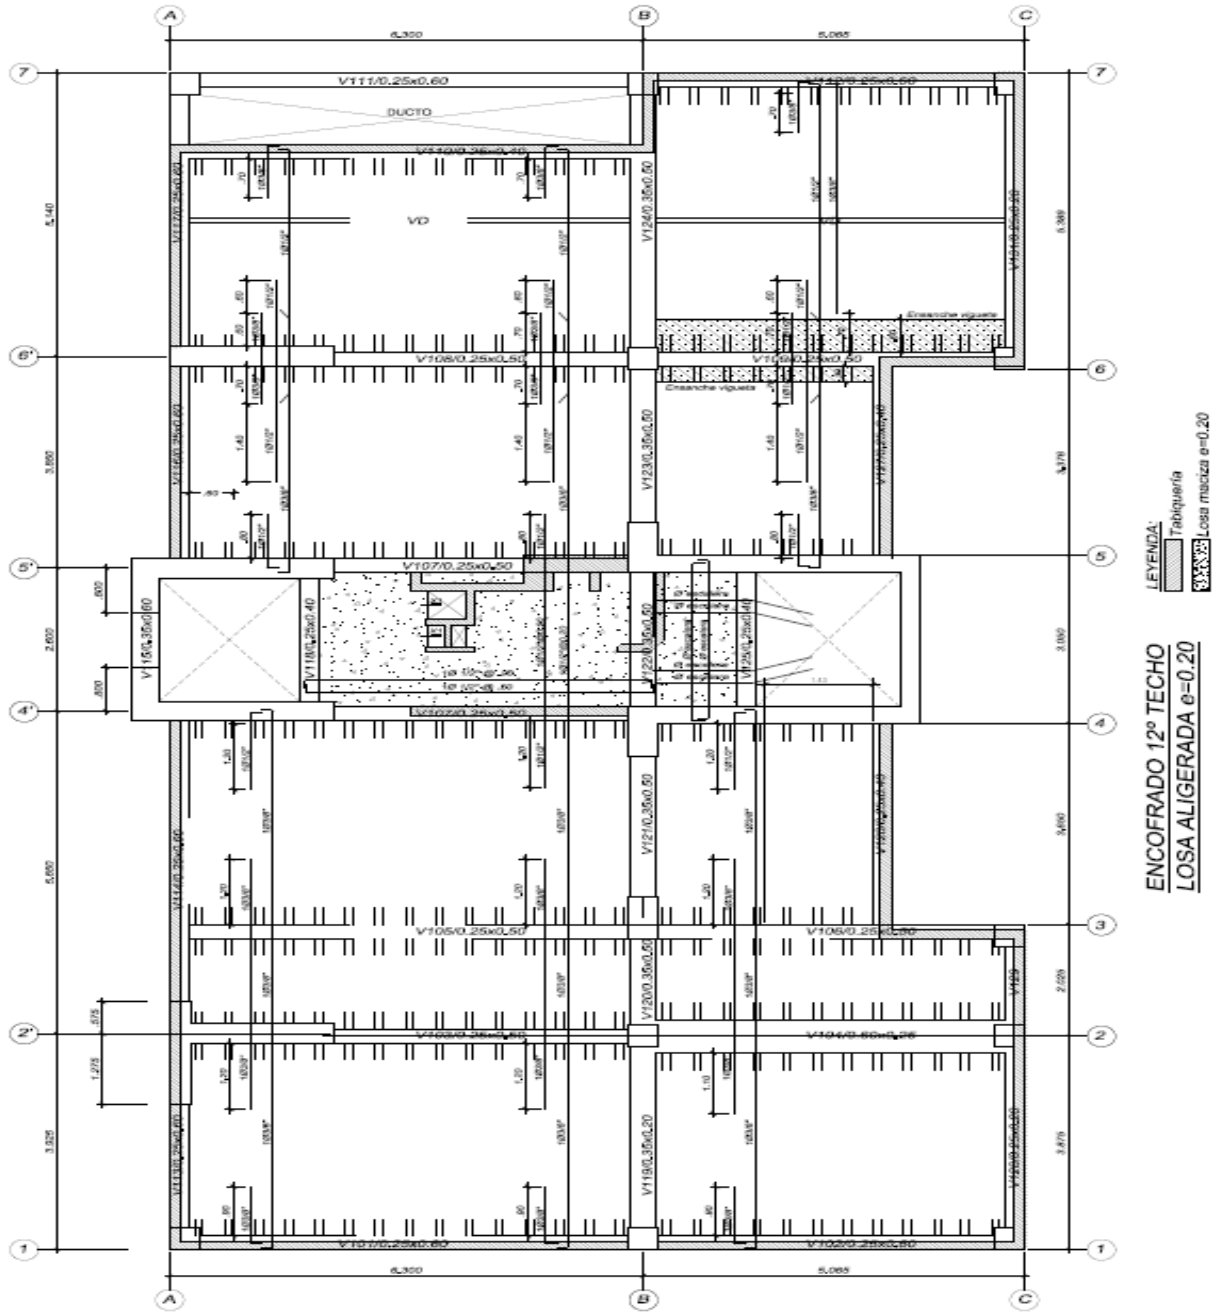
Detalle del refuerzo dispuesto en la losa maciza Icr
